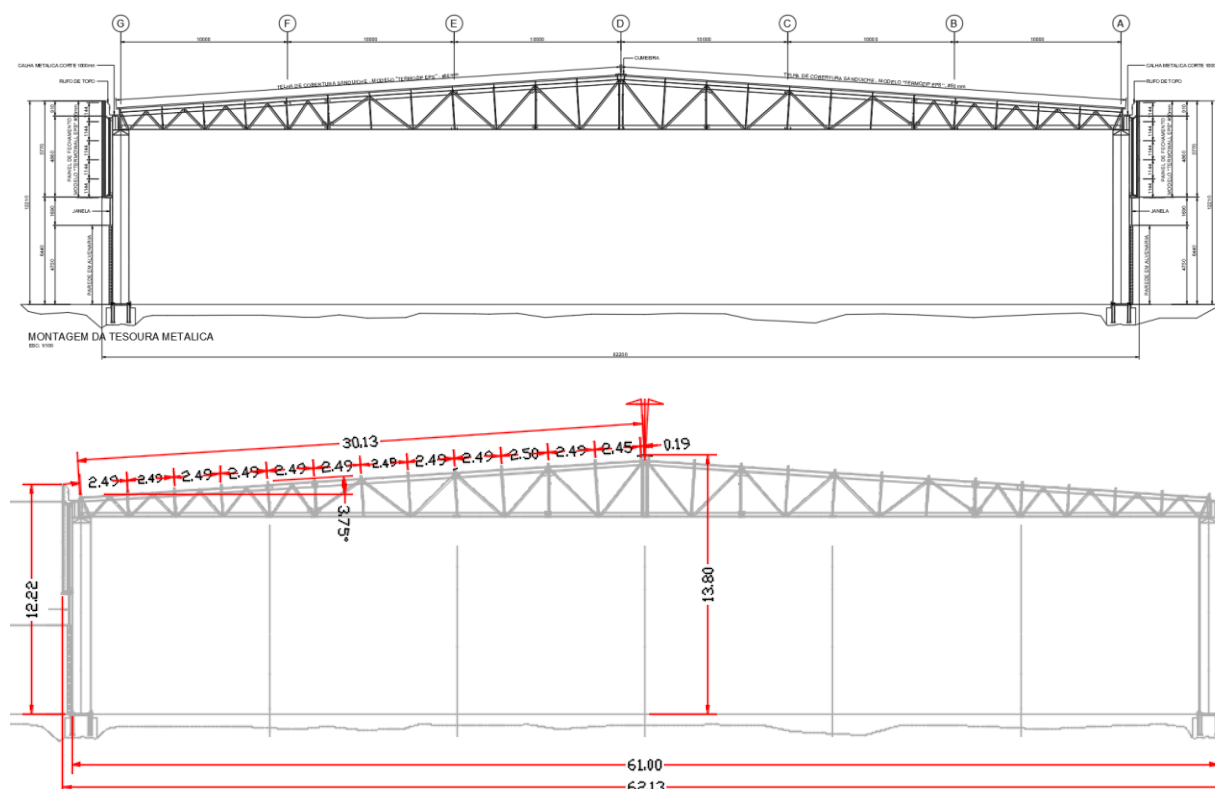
Corte Transversal da Edificação em Estudo – Tesouras e Posição Terças
